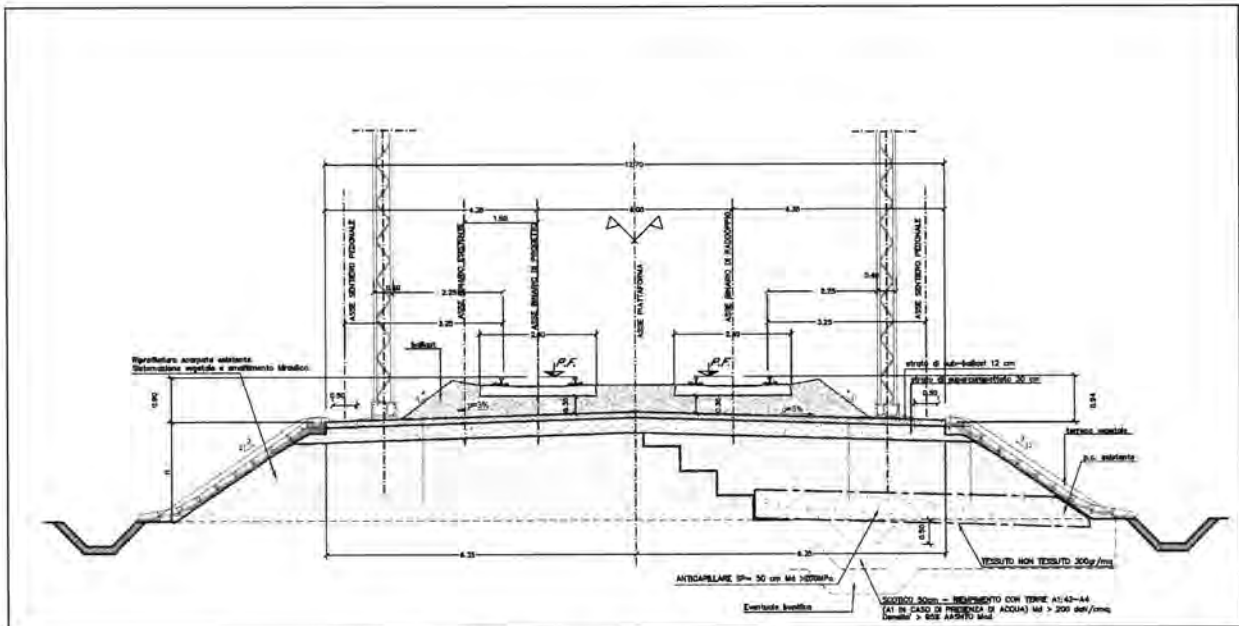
Sezione tipo rilevato in affiancamento.
